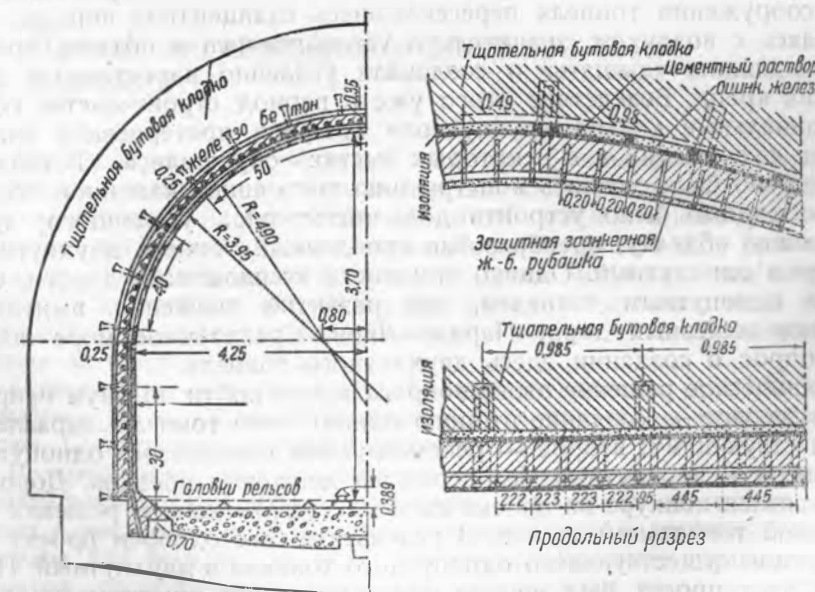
Новая тоннельная обделка. Изоляция и детали укрепления внутренней железобетонной оболочки.
